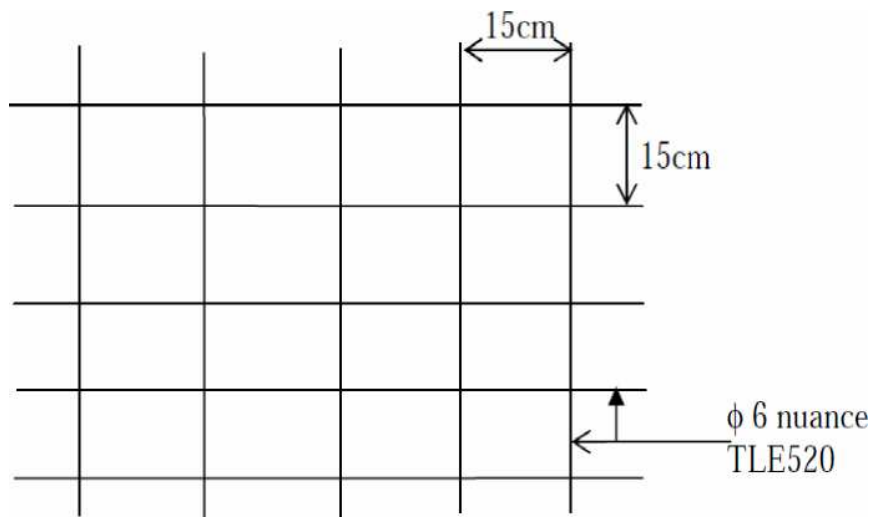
Ferrailage de la dalle de compression avec un treillis soudé (15×15) cm
